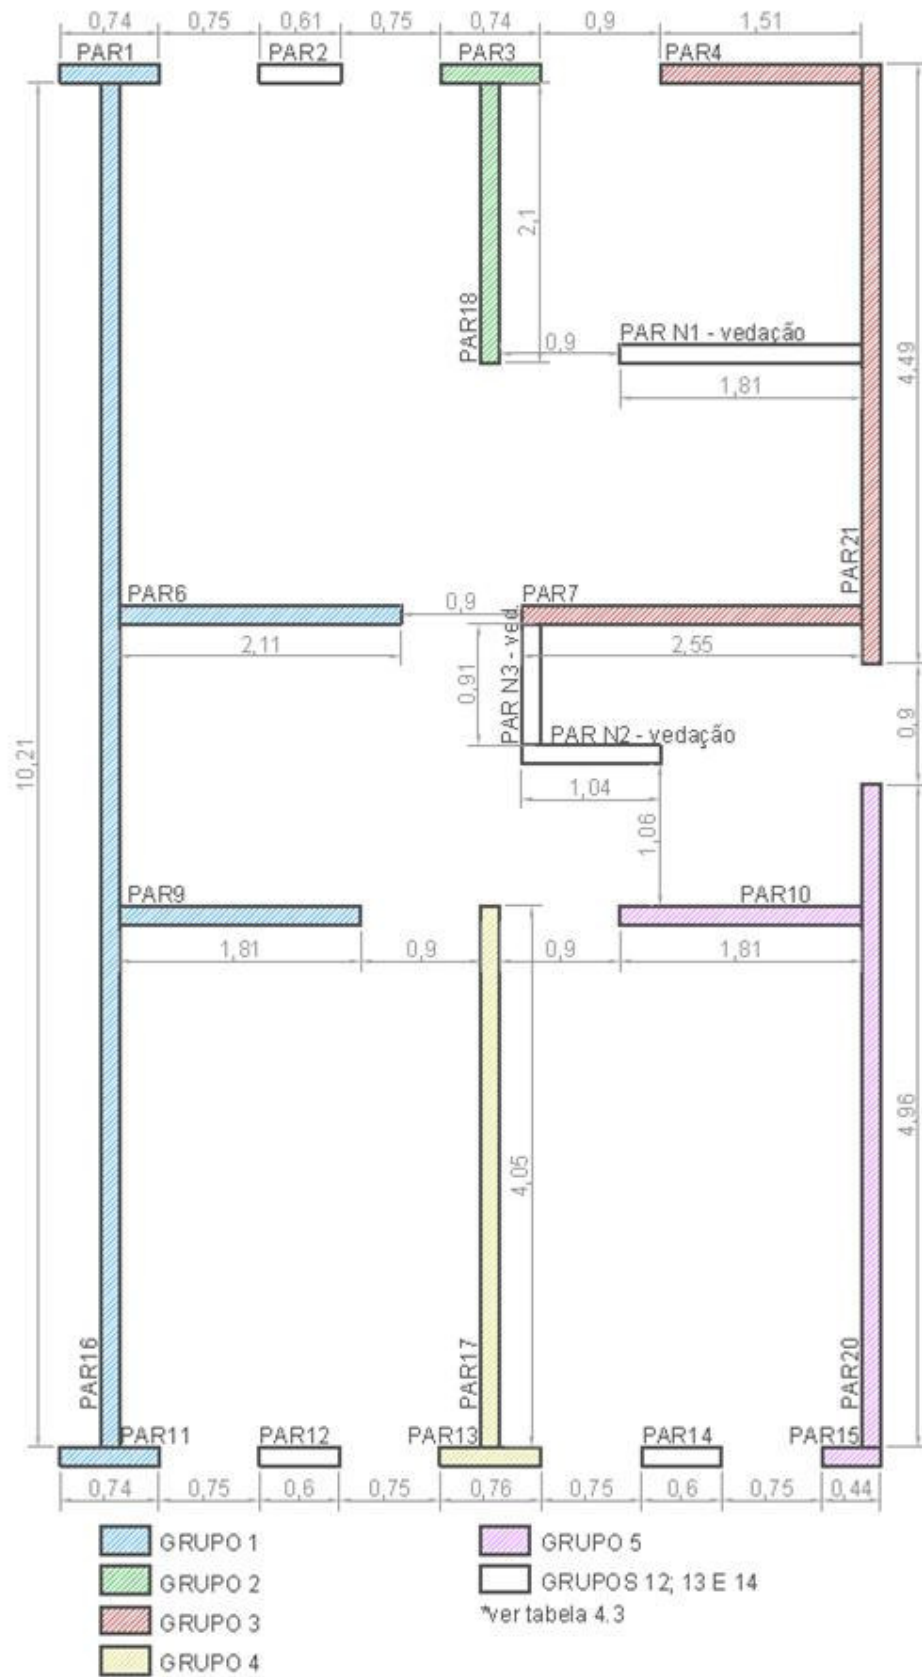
3 Separação das paredes em grupos isolados, Pavimento Superior.
